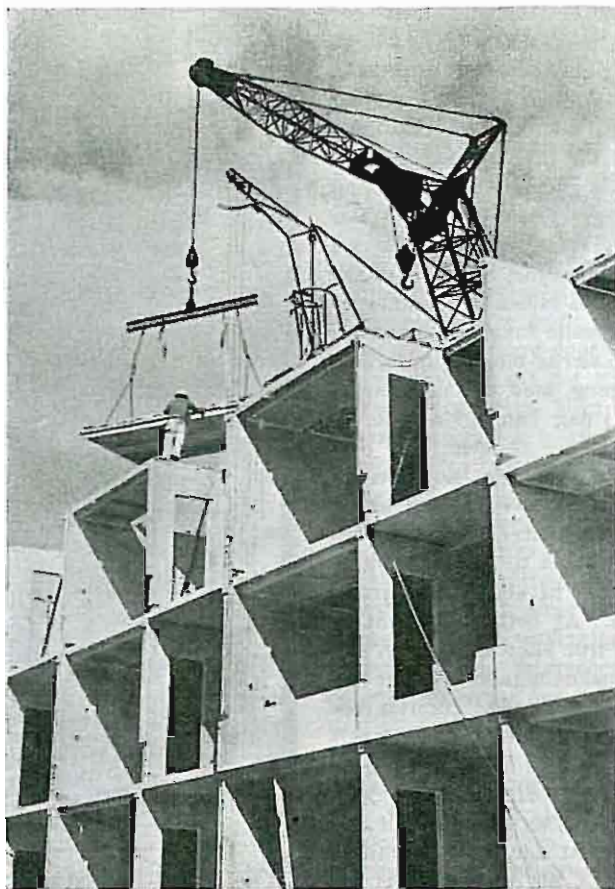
Torveparken, montagebyggeriets videre udvikling, hvor også de bærende skillerum er udført af fabriksfremstillede elementer og hvor installationerne er færdige fra fabrik.
